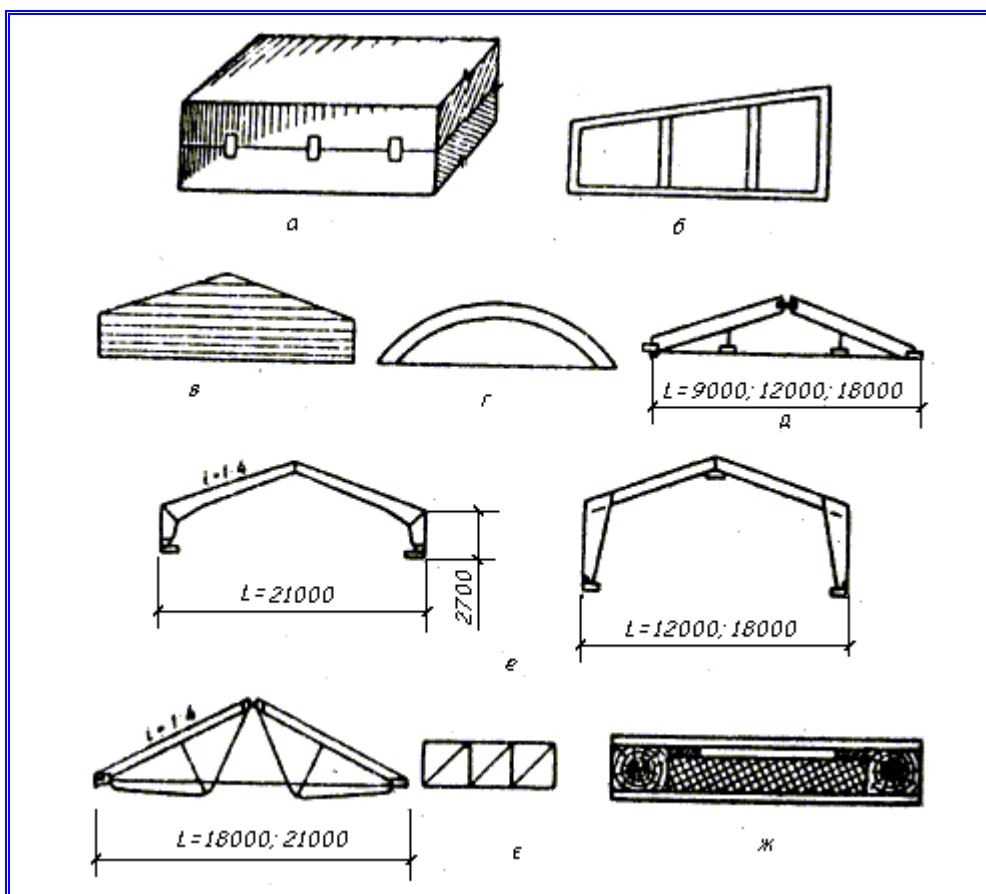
Будівельні конструкції із деревини: а – балка на нагелях; б – балка з фанери; в – дощата балка; г – арка кругового обрису; д – трикутна арка; е – рами; є – ферми; ж – панель покриття.
